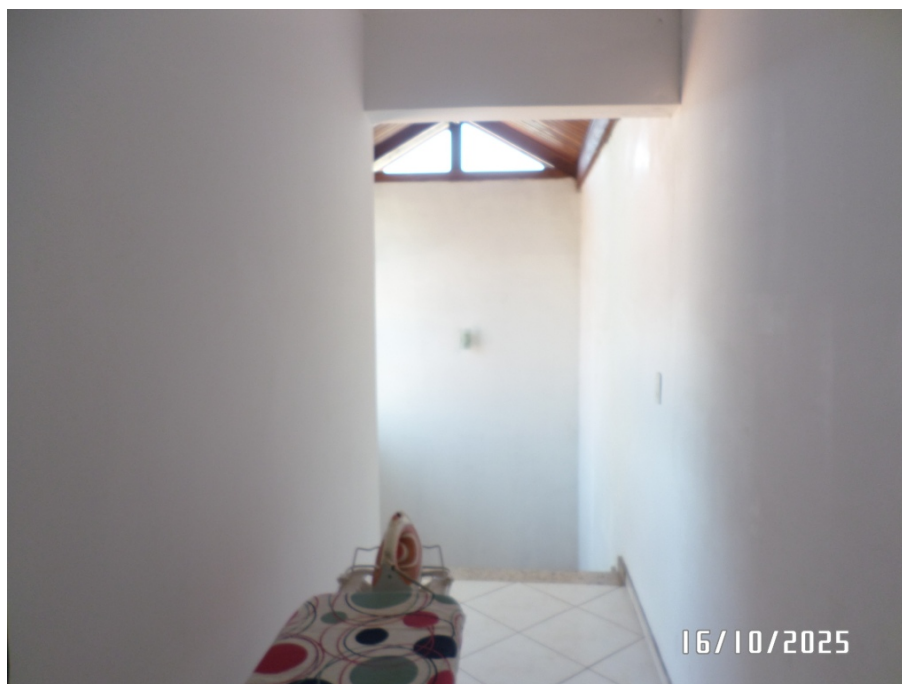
VISTA PARCIAL TÉRREO – HALL PARA ESCADA SECUNDÁRIA.
